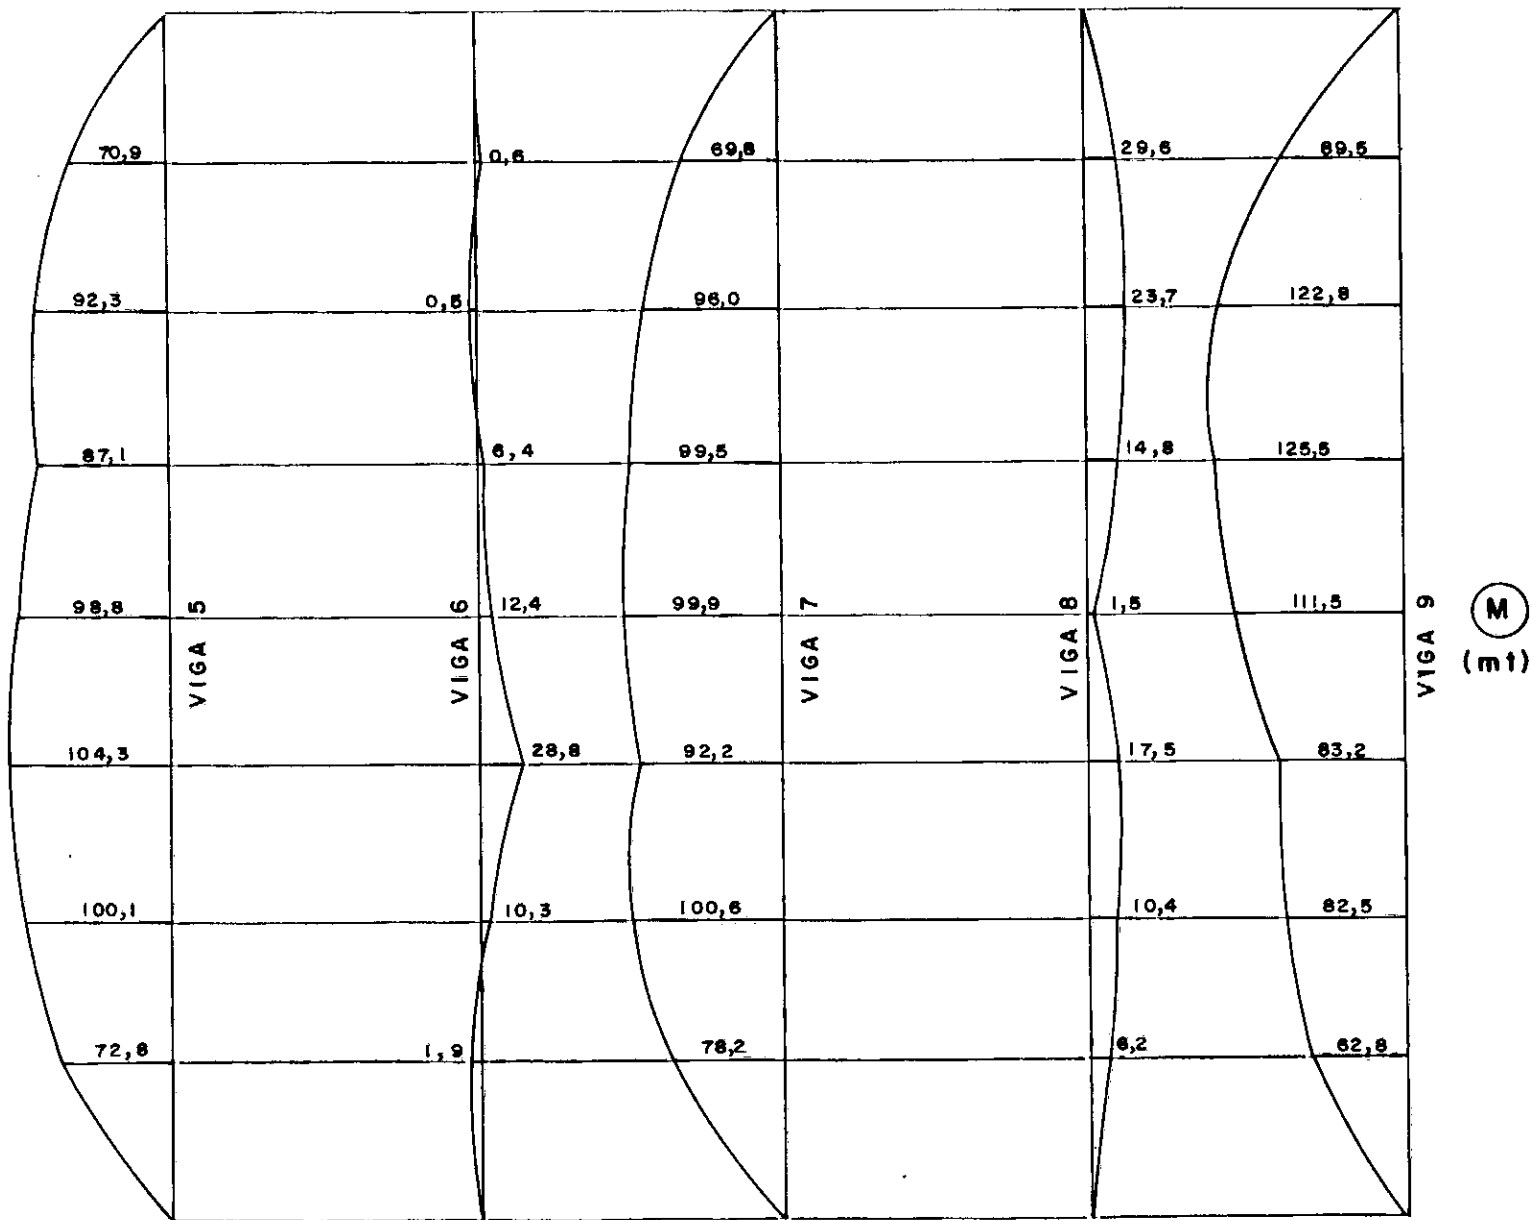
VIGA SOBRE BASE ELÁSTICA
